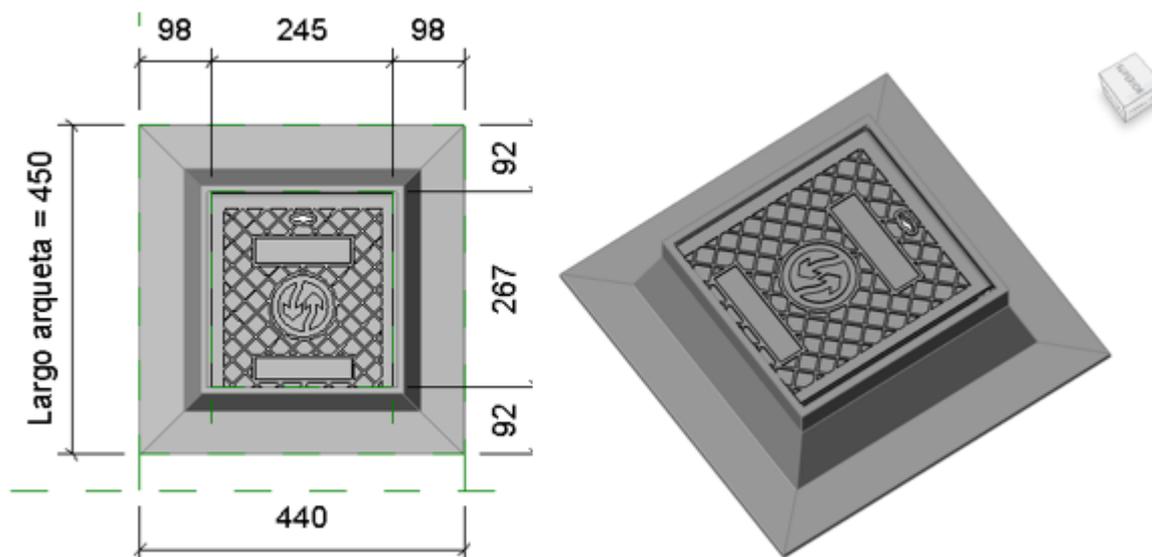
Vista superior del conjunto arqueta + tapa según dimensiones de la instrucción técnica.
